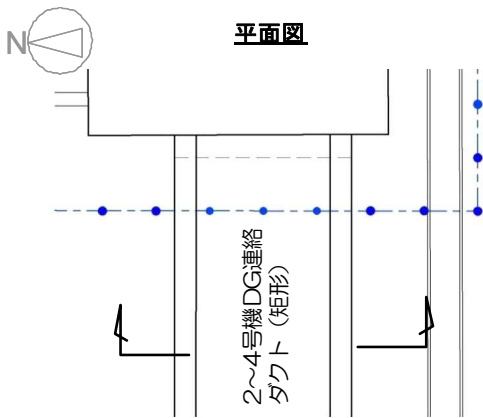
【6-7】4号機主変圧器ケーブルダクト 施工方法（貫通施工）
